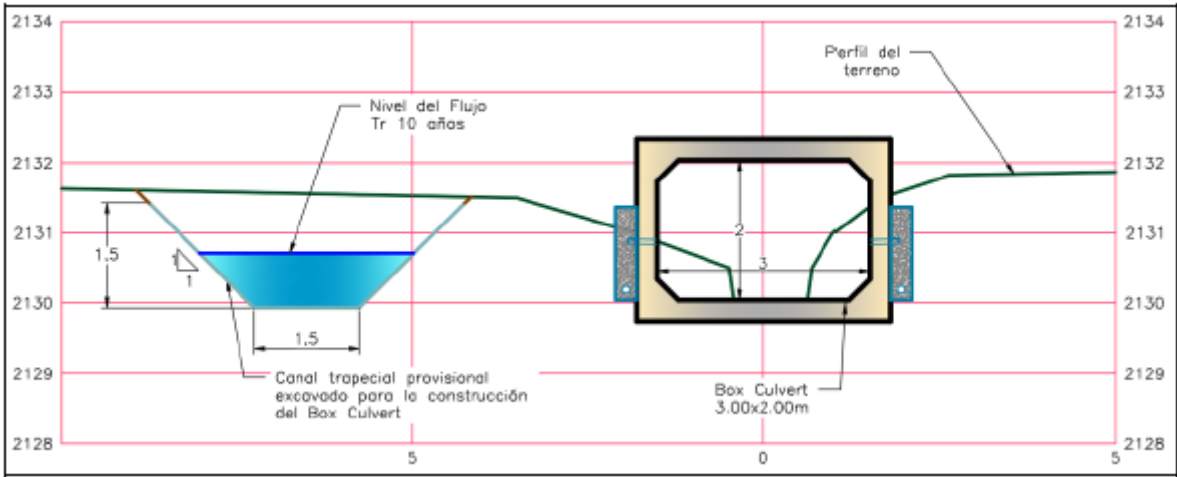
Sección transversal de canal provisional durante el proceso constructivo de los Box Culvert N°1, 2, 3 y 4
